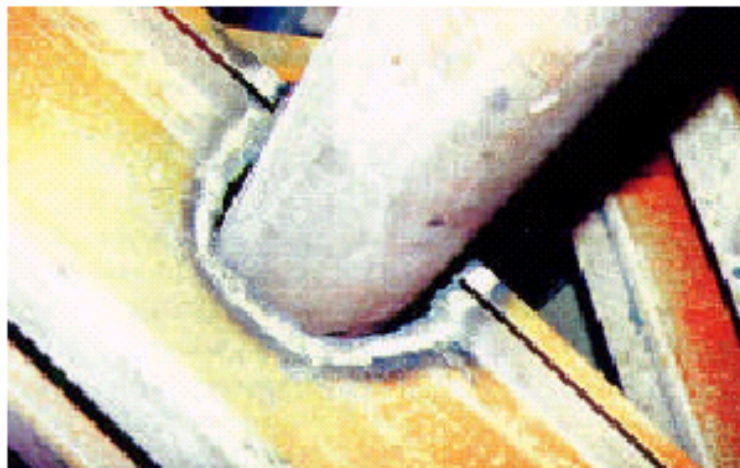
Furo para passagem de tubulação hidráulica (SANTOS, 1998)
